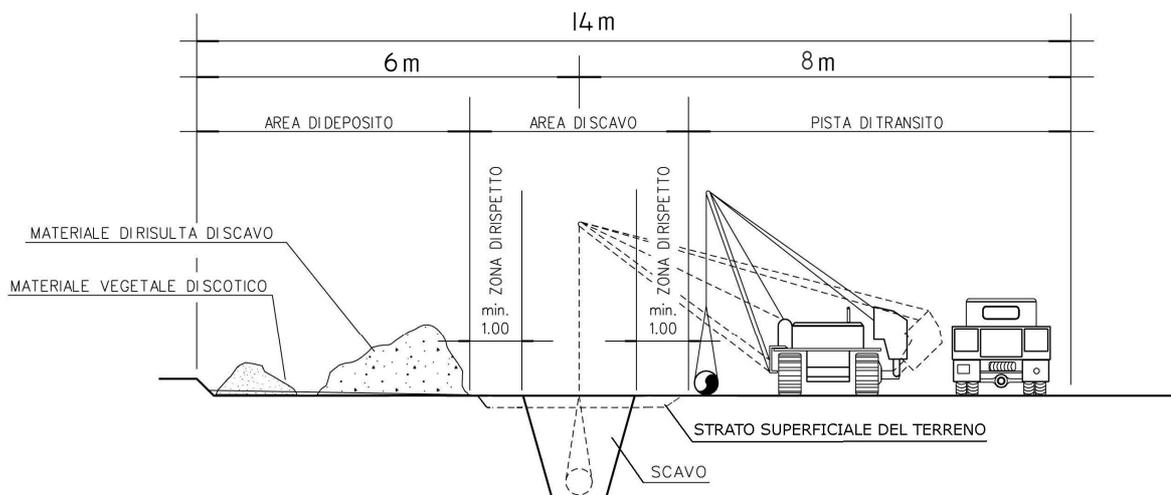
Sezione fascia di lavoro in installazione nuova condotta
